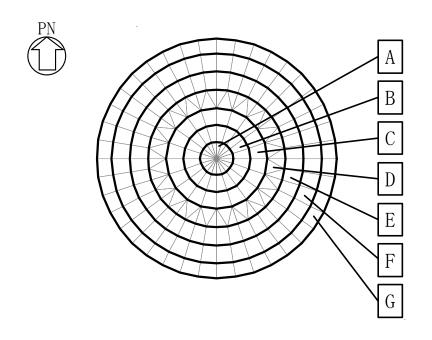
原子炉格納容器底部コンクリートマットの配筋区分
